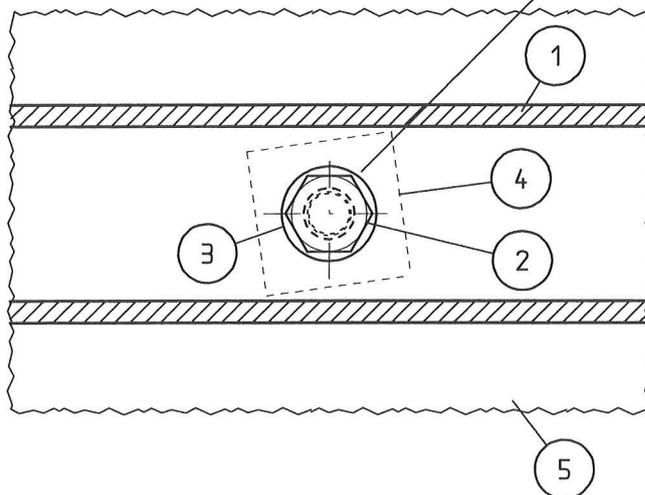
# DETAIL PLATTENTRAGPROFIL MIT GEWINDEHÜLSE M6
